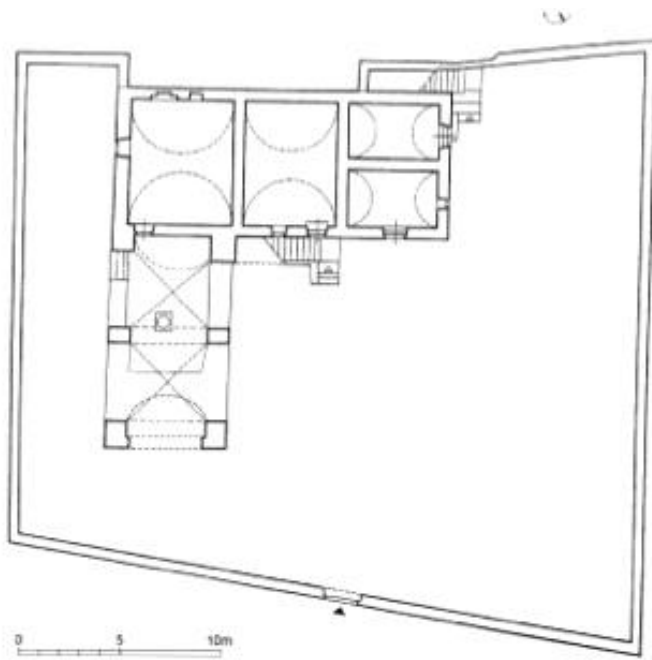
Knežev dvor auf Šipan, Grundriss Erdgeschoss
